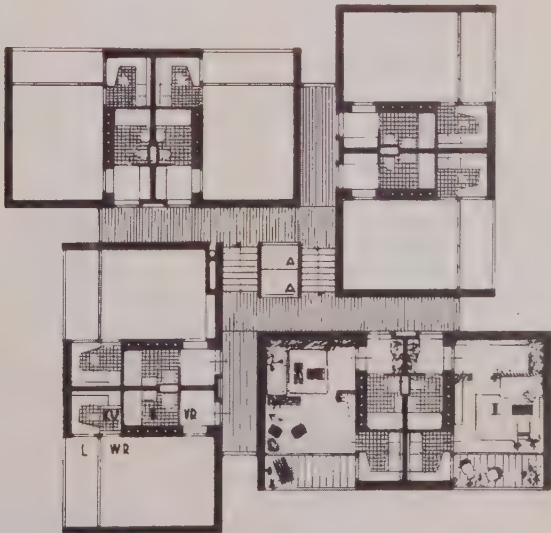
Wohngeschoßgrundriß des Wohnhochhauses in Linz
